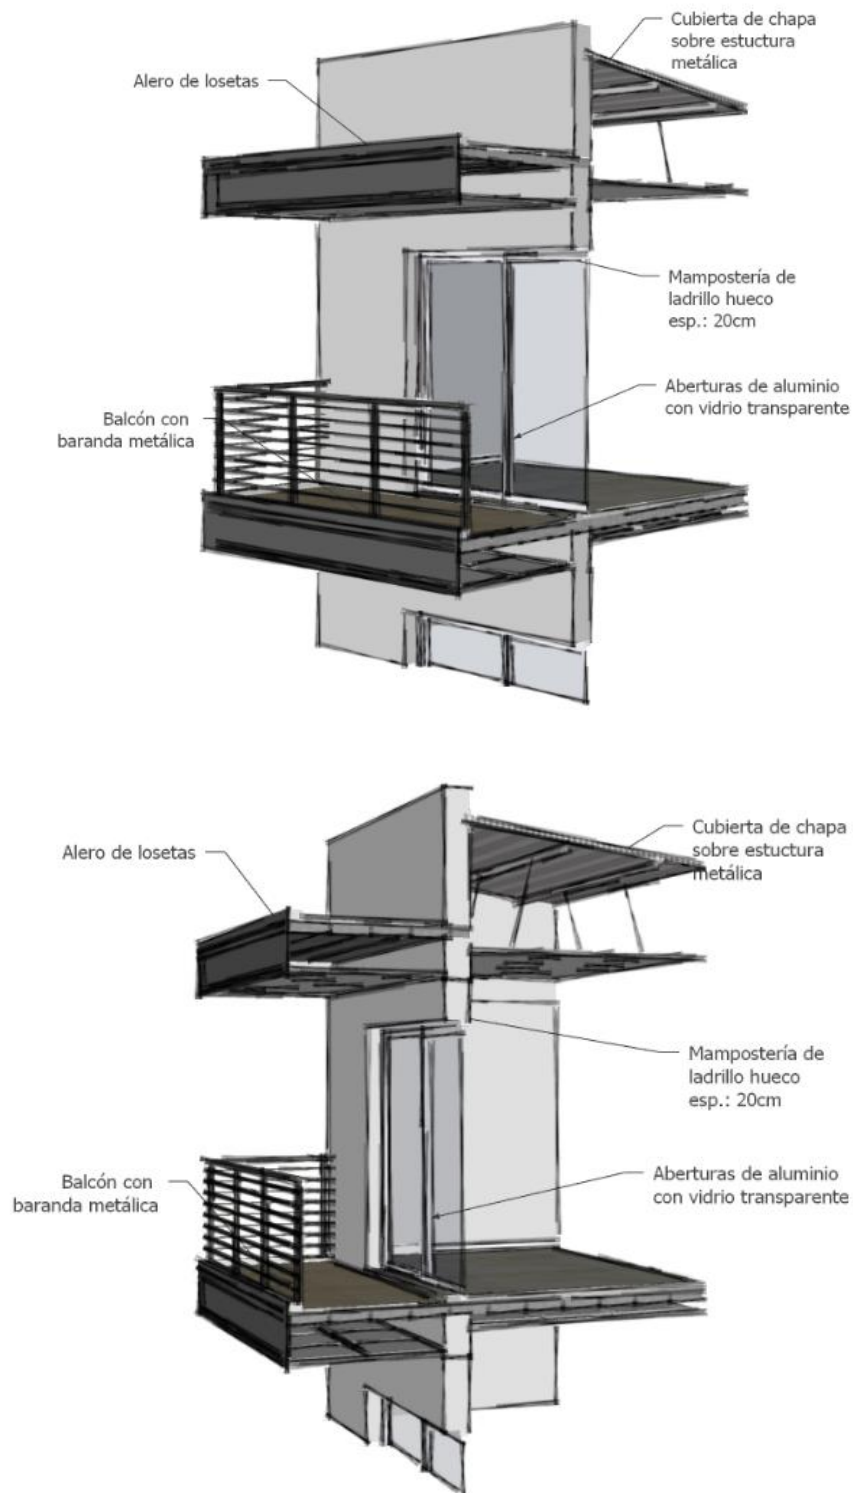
Esquema de paquete constructivo (pared-techo) de situación original. - Fuente: elaboración propia.
